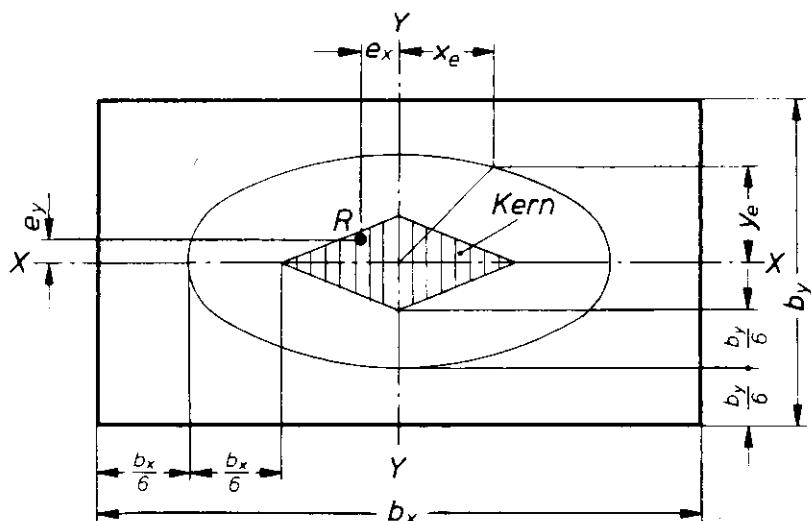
Grundriß eines rechteckigen Fundaments; Bezeichnungen bei zweiachsiger Verkantung
